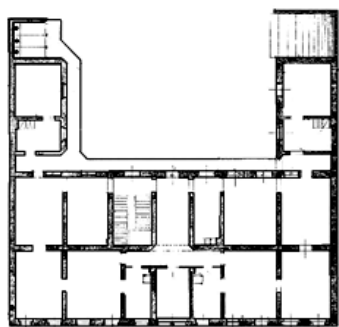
План другого поверху будинку за адресою Городоцька, 73. 1875 р. (Сільник, 2008)
